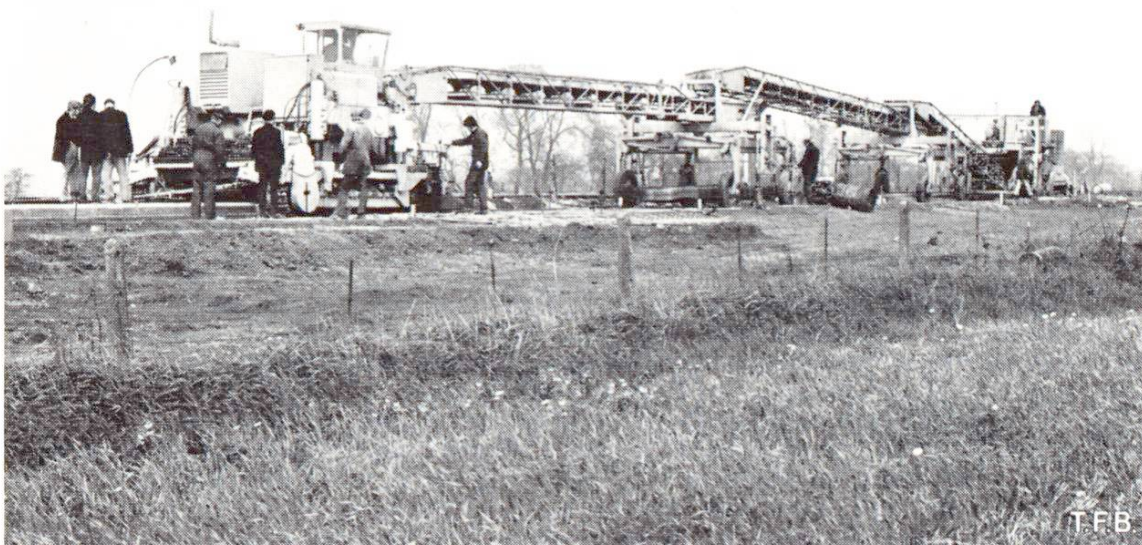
Einbauzug für Geleiseunterbau aus Beton. Rechts an der Spitze befindet sich die Betonaufgabe mit anhebbarer Vorratssilo. Es folgen zwei fahrbare «Kranböcke» mit den Armierungsnetzen für die untere und obere Bewehrungslage und schliesslich der Gleitschalentrichter und die Maschine, welche die Dübellöcher im frischen Beton erstellt (ganz links). Über die Kranböcke führt das Transportband für den Frischbeton.
